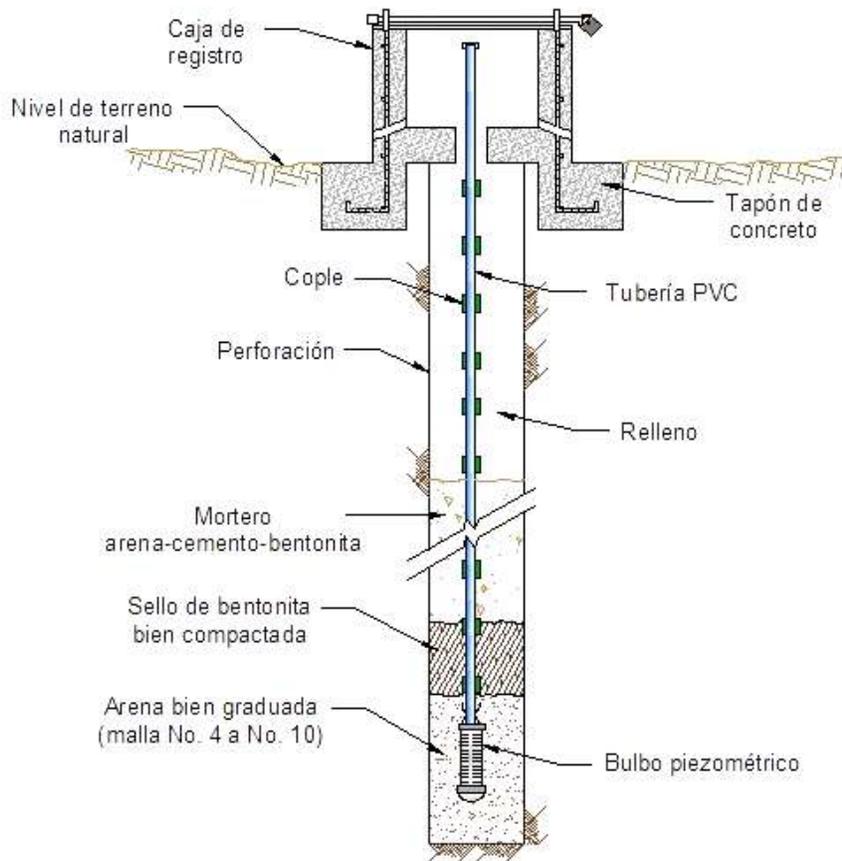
FIGURA. Instalación de piezómetro abierto tipo Casagrande.
